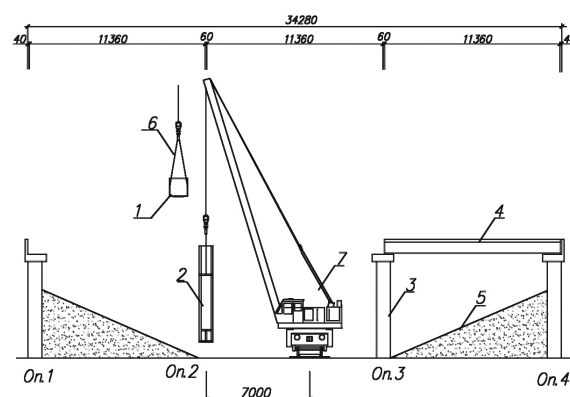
Монтаж опоры № 2: 1 – ригель опоры; 2 – колонна опоры № 2; 3 – опора № 3; 4 – балки пролета 3-4; 5 – откосы; 6 – строп; 7 – кран
